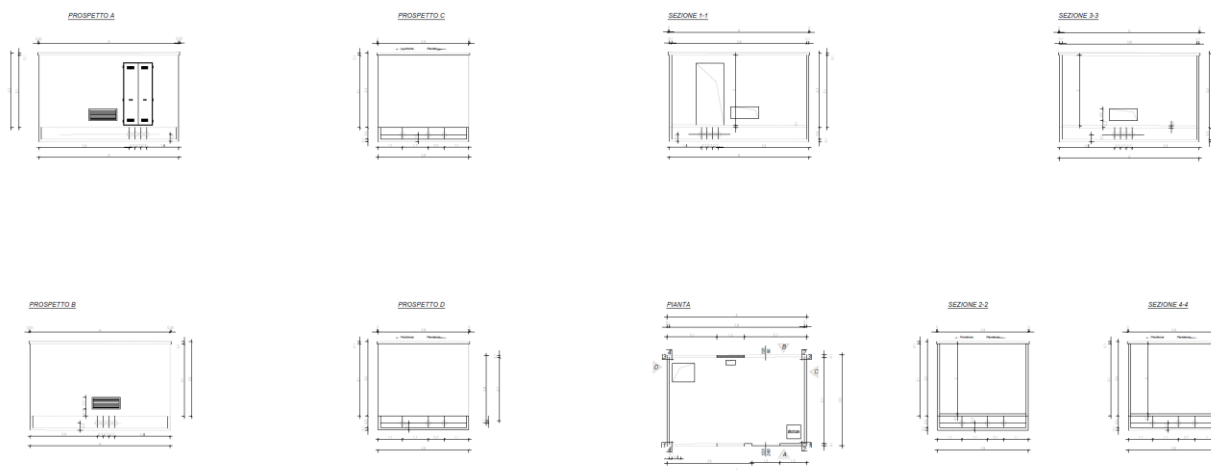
prospetti, sezione e pianta delle cabine di sottocampo.
